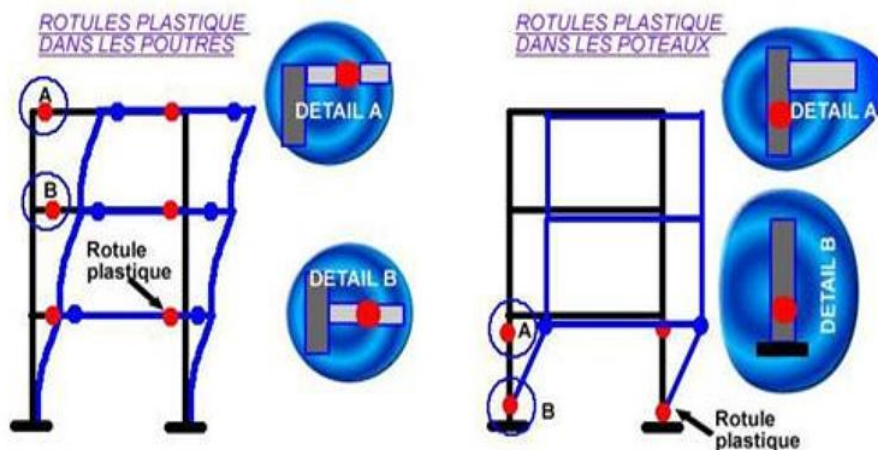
Rotules plastiques au niveau des poteaux et des poutres [18].
